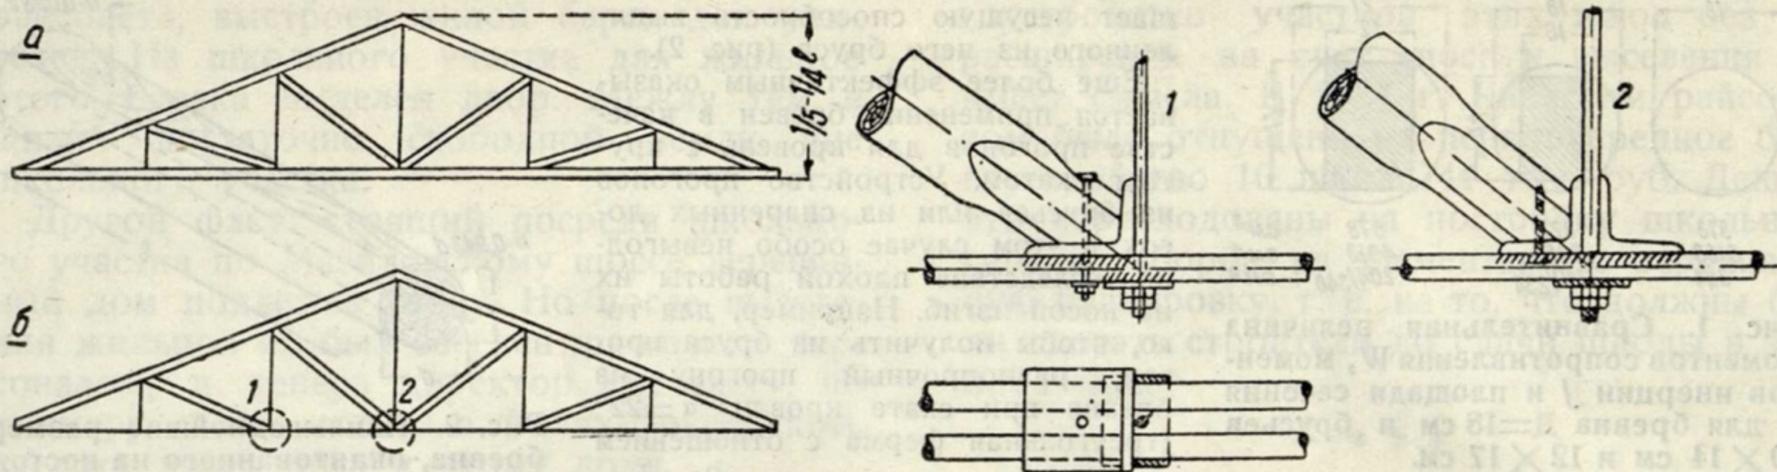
а) Треугольная ферма с растянутыми стойками из железа и сжатыми раскосами из круглой древесины; б) ферма с нижним поясом из железа.
